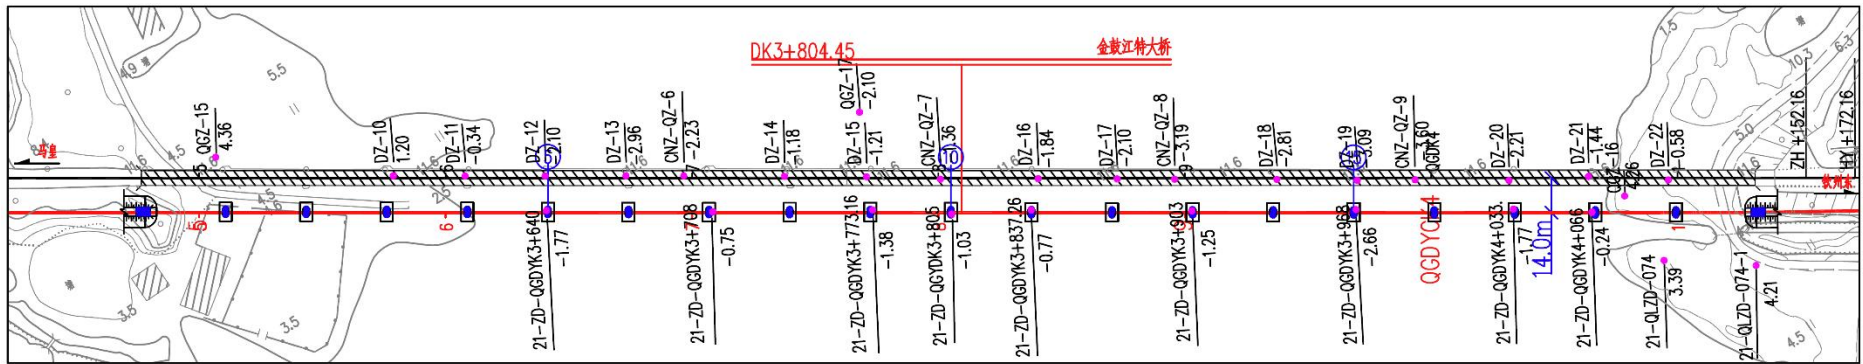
金鼓江特大桥梁钻孔平面布置图
